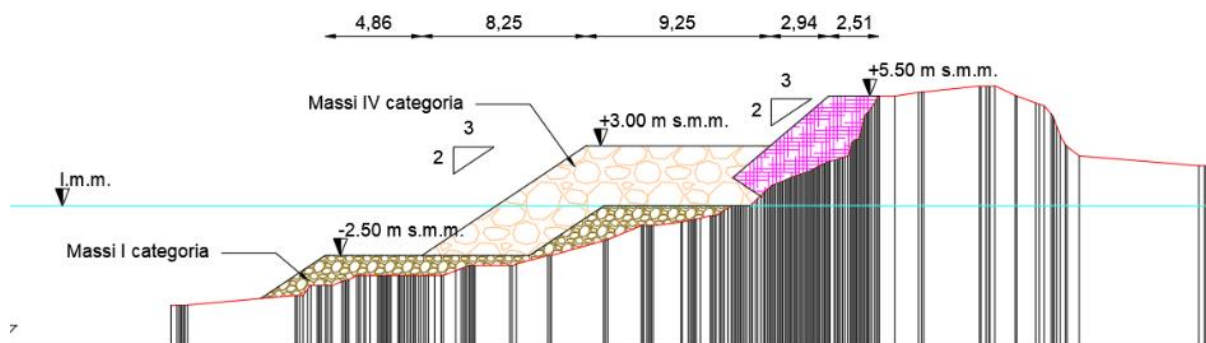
Sezione tipo del tratto compreso fra la sezione 5 e la sezione 7
